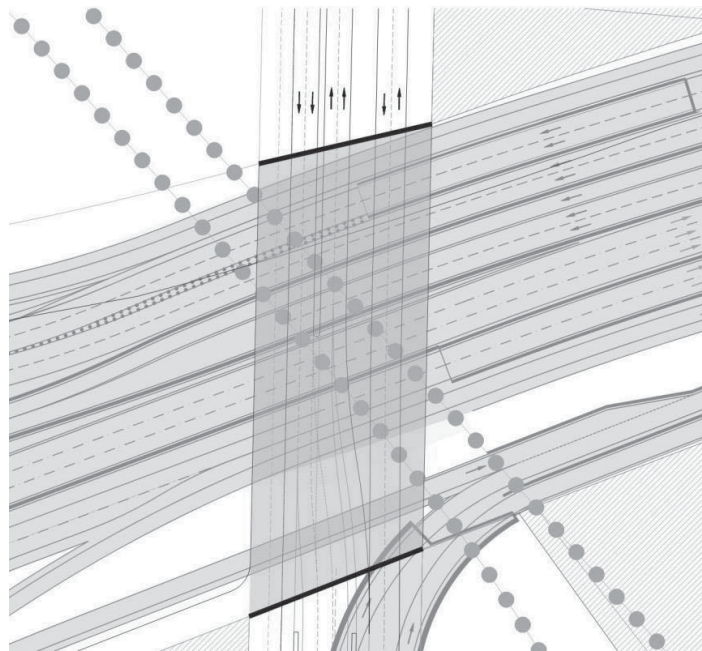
Planta del puente de la calle de Agustín de Foxá sobre Calle 30 y las vías del FC.
